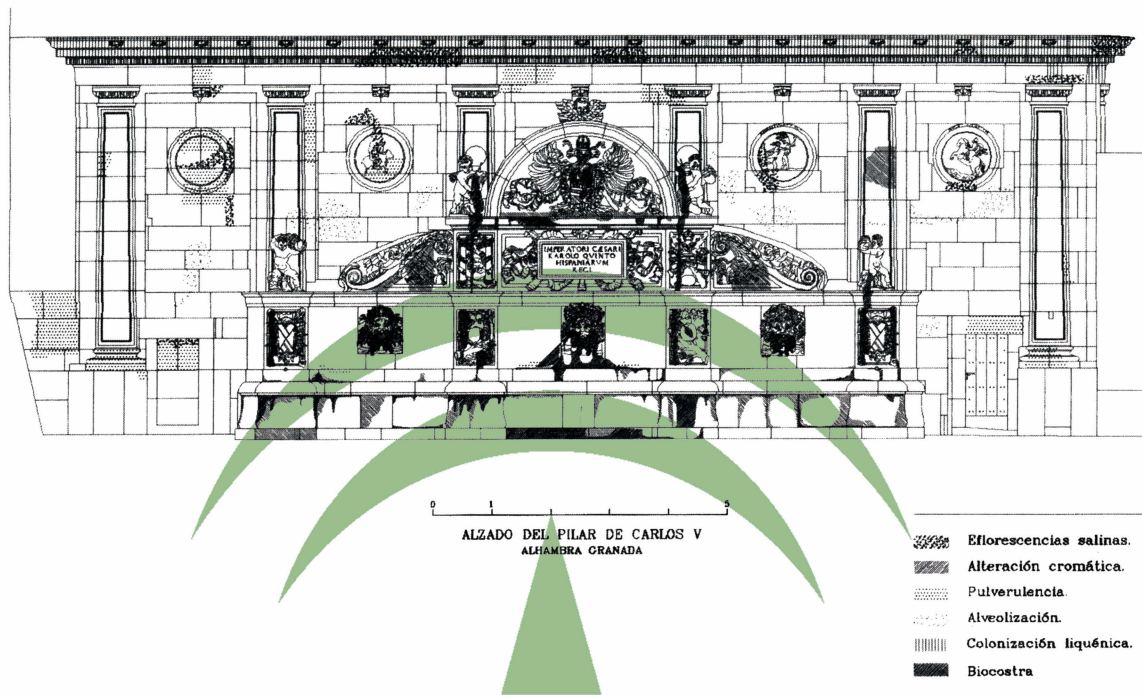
Alzado del pilar de Carlos V. Estado inicial.
